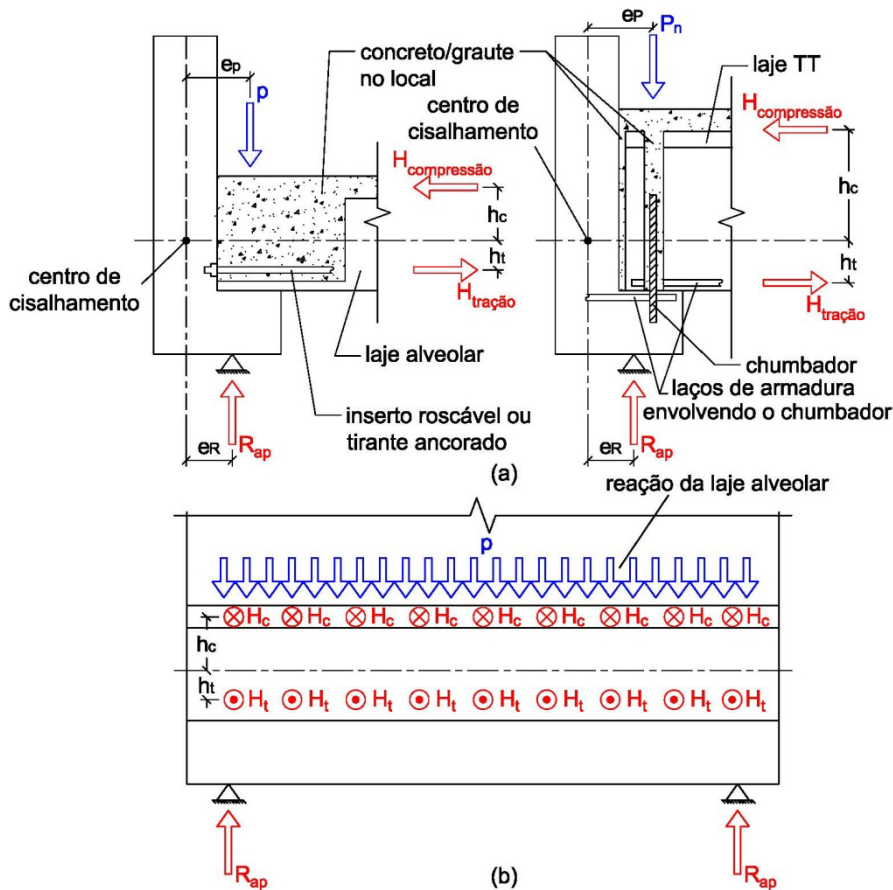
Esquema de cargas gravitacionais para vigas em que a torção é equilibrada pela ligação viga-laje ao longo do eixo longitudinal (a) vista transversal das opções com laje alveolar e com laje TT e (b) vista longitudinal da opção com laje alveolar [adaptado de Bachmann e Steinle (2011) e FIB (2008)].
